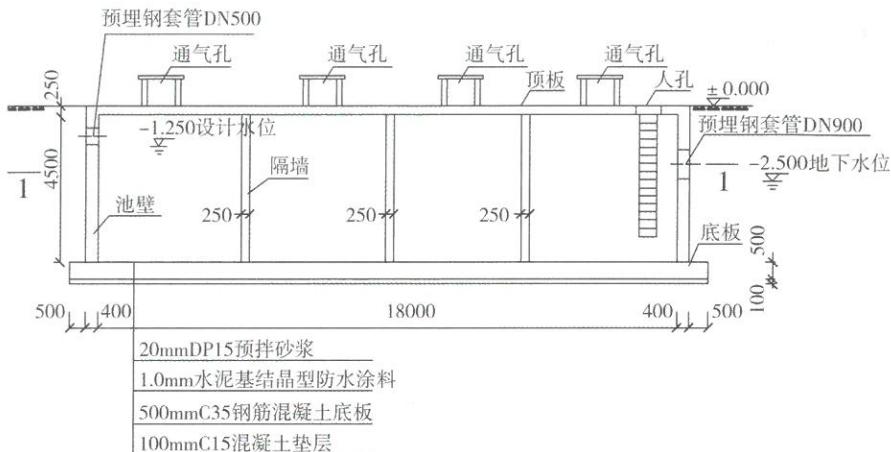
水池剖面图(标高单位: m; 尺寸单位: mm)
